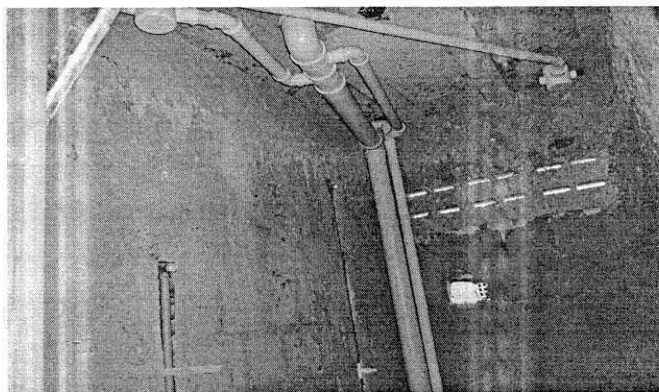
Instalações de água fria e esgoto nos banheiros.
